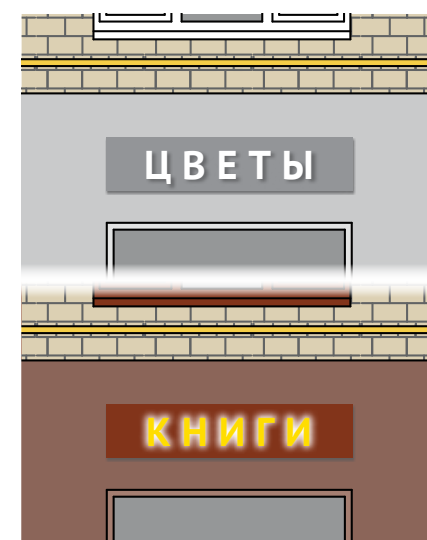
Хорошо: цвет подложки в гамме фасада здания
